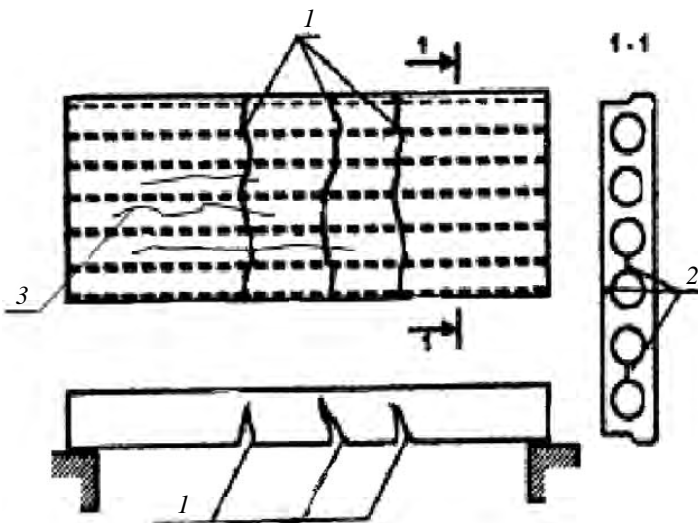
«Силловые» и технологические трещины в пустотной панели перекрытия:
